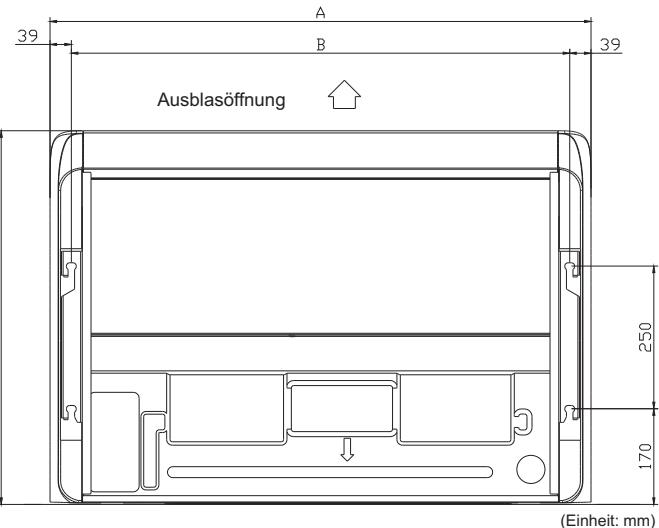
Befestigung der Aufhängungsbolzen
